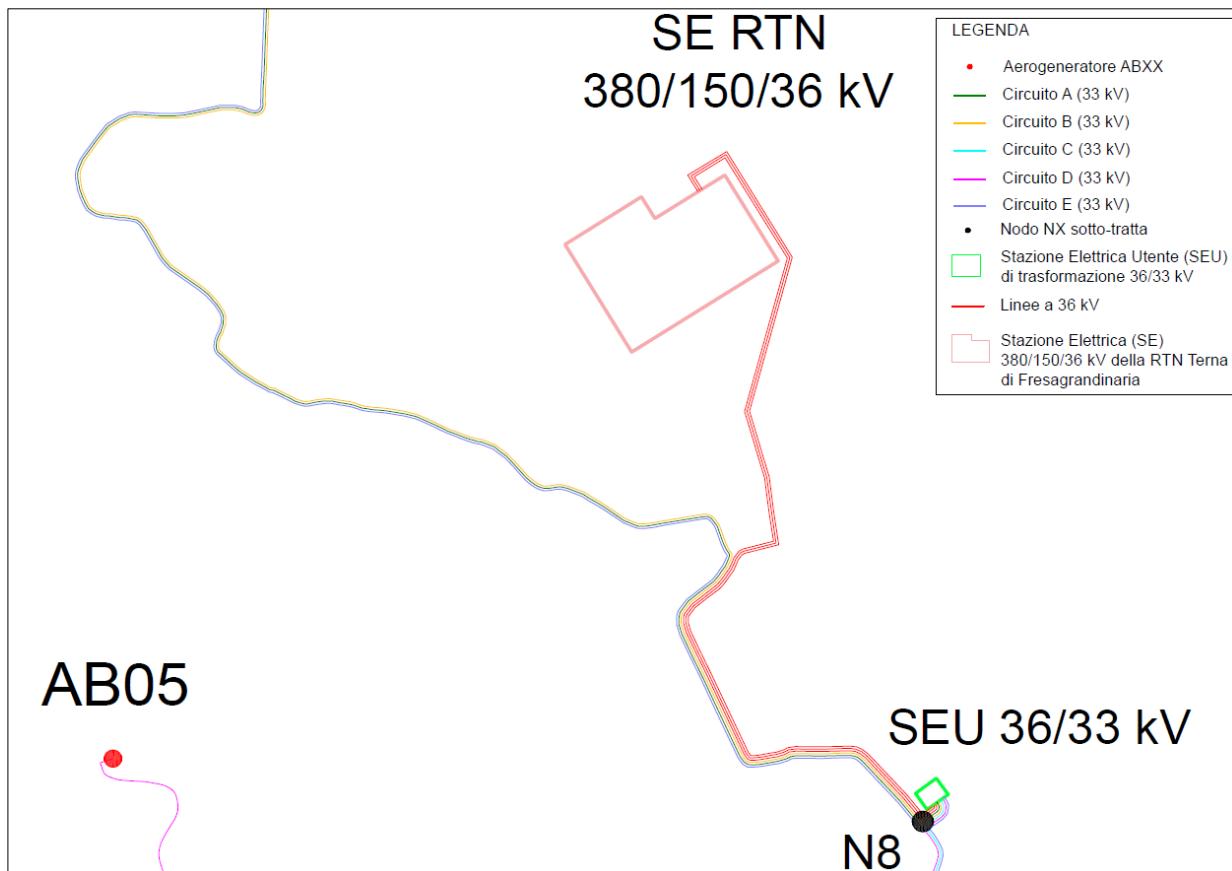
Dettaglio 3 di 4 della planimetria generale di distribuzione linee elettriche
